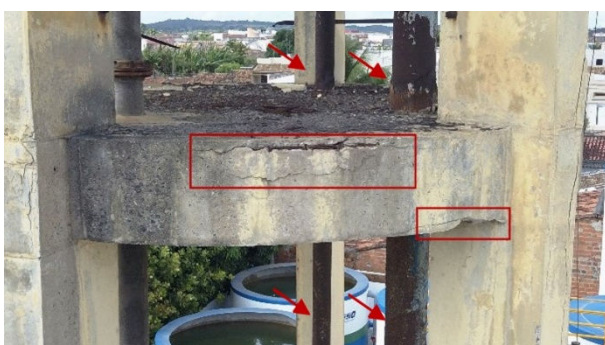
Detalhe do 3º nível de viga, em destaque corrosão e deslocamento da armadura (retângulos) e tubulações com corrosão generalizada (setas)
